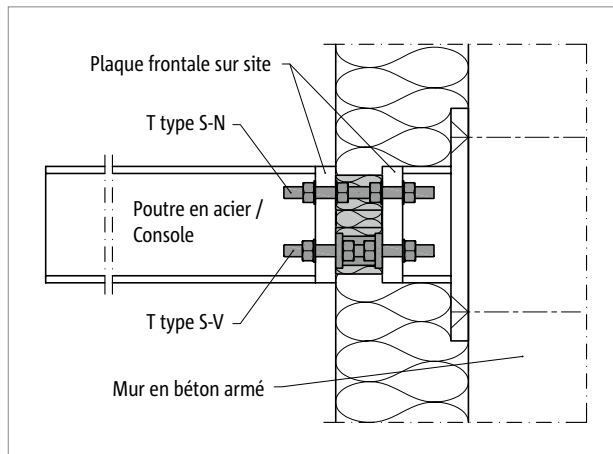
Schöck Isokorb® T type S-N et T type S-V : raccordement de structure en acier sur béton armé
